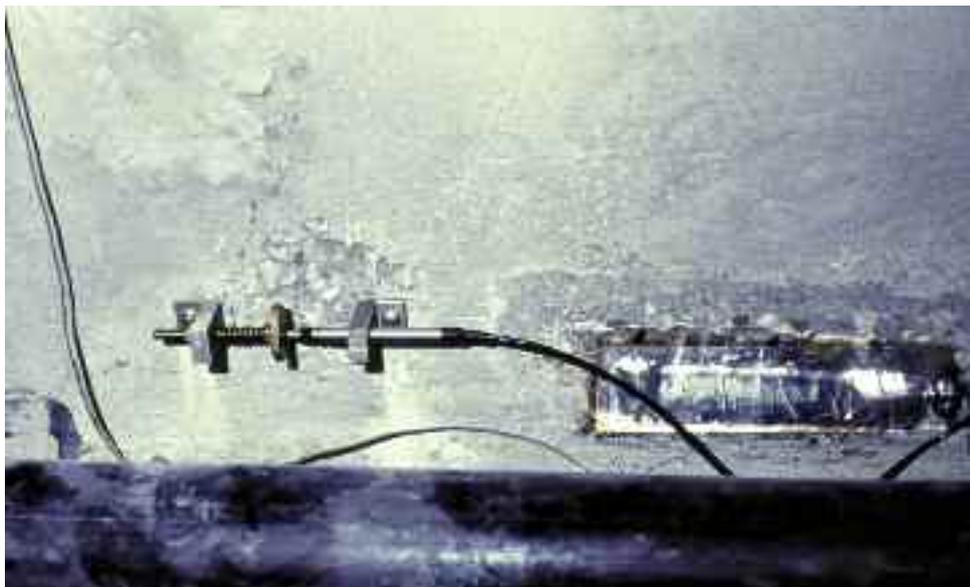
couple jauge - capteur (crédit photo D. Poineau)
